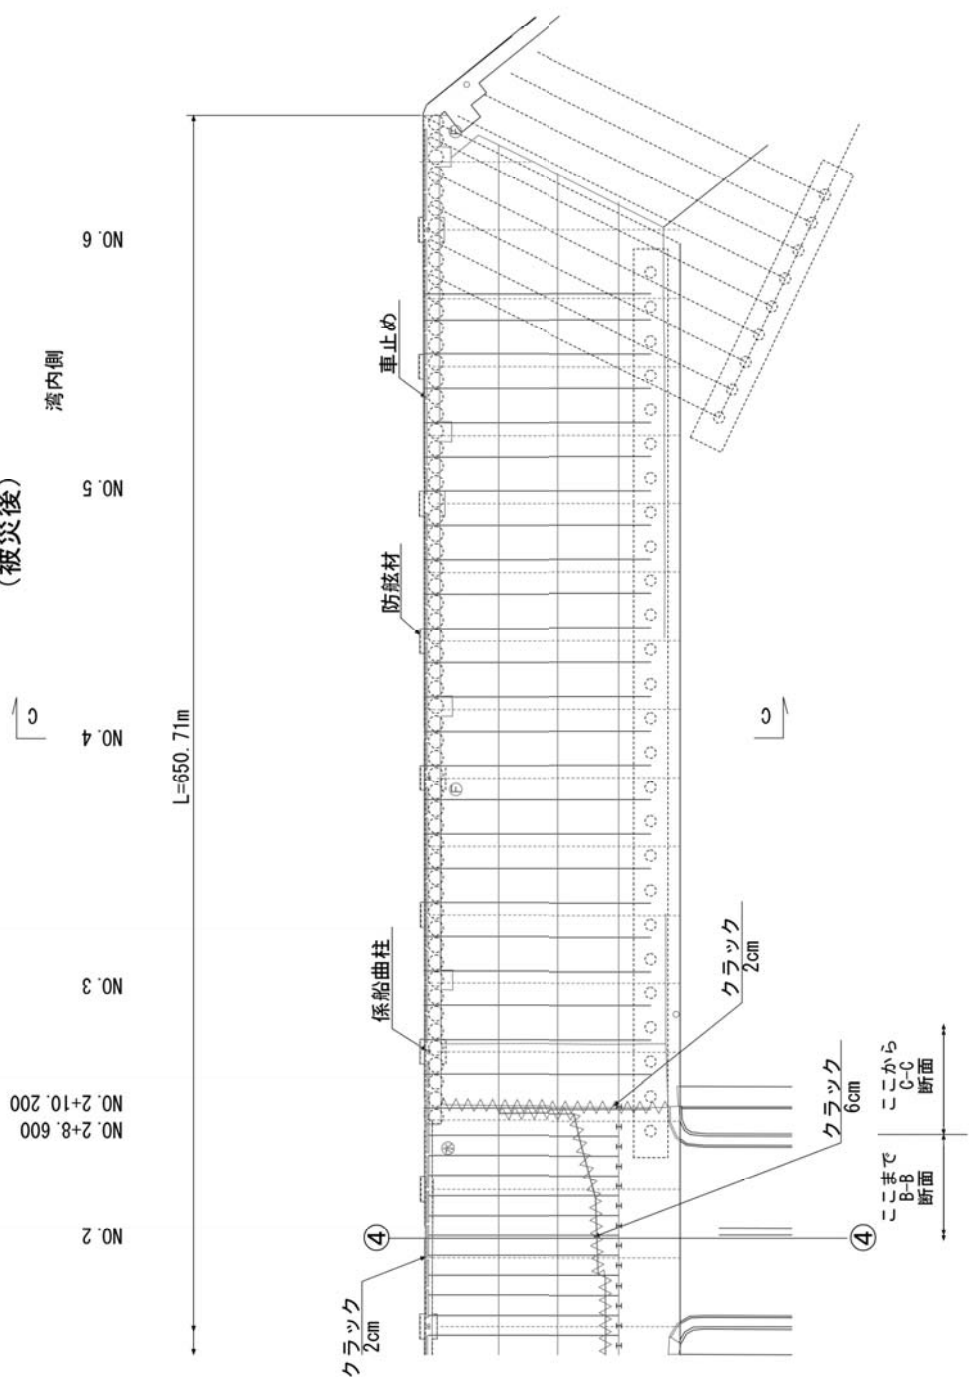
箱崎埠頭-7.5m 岸壁の被災状況詳細平面図
